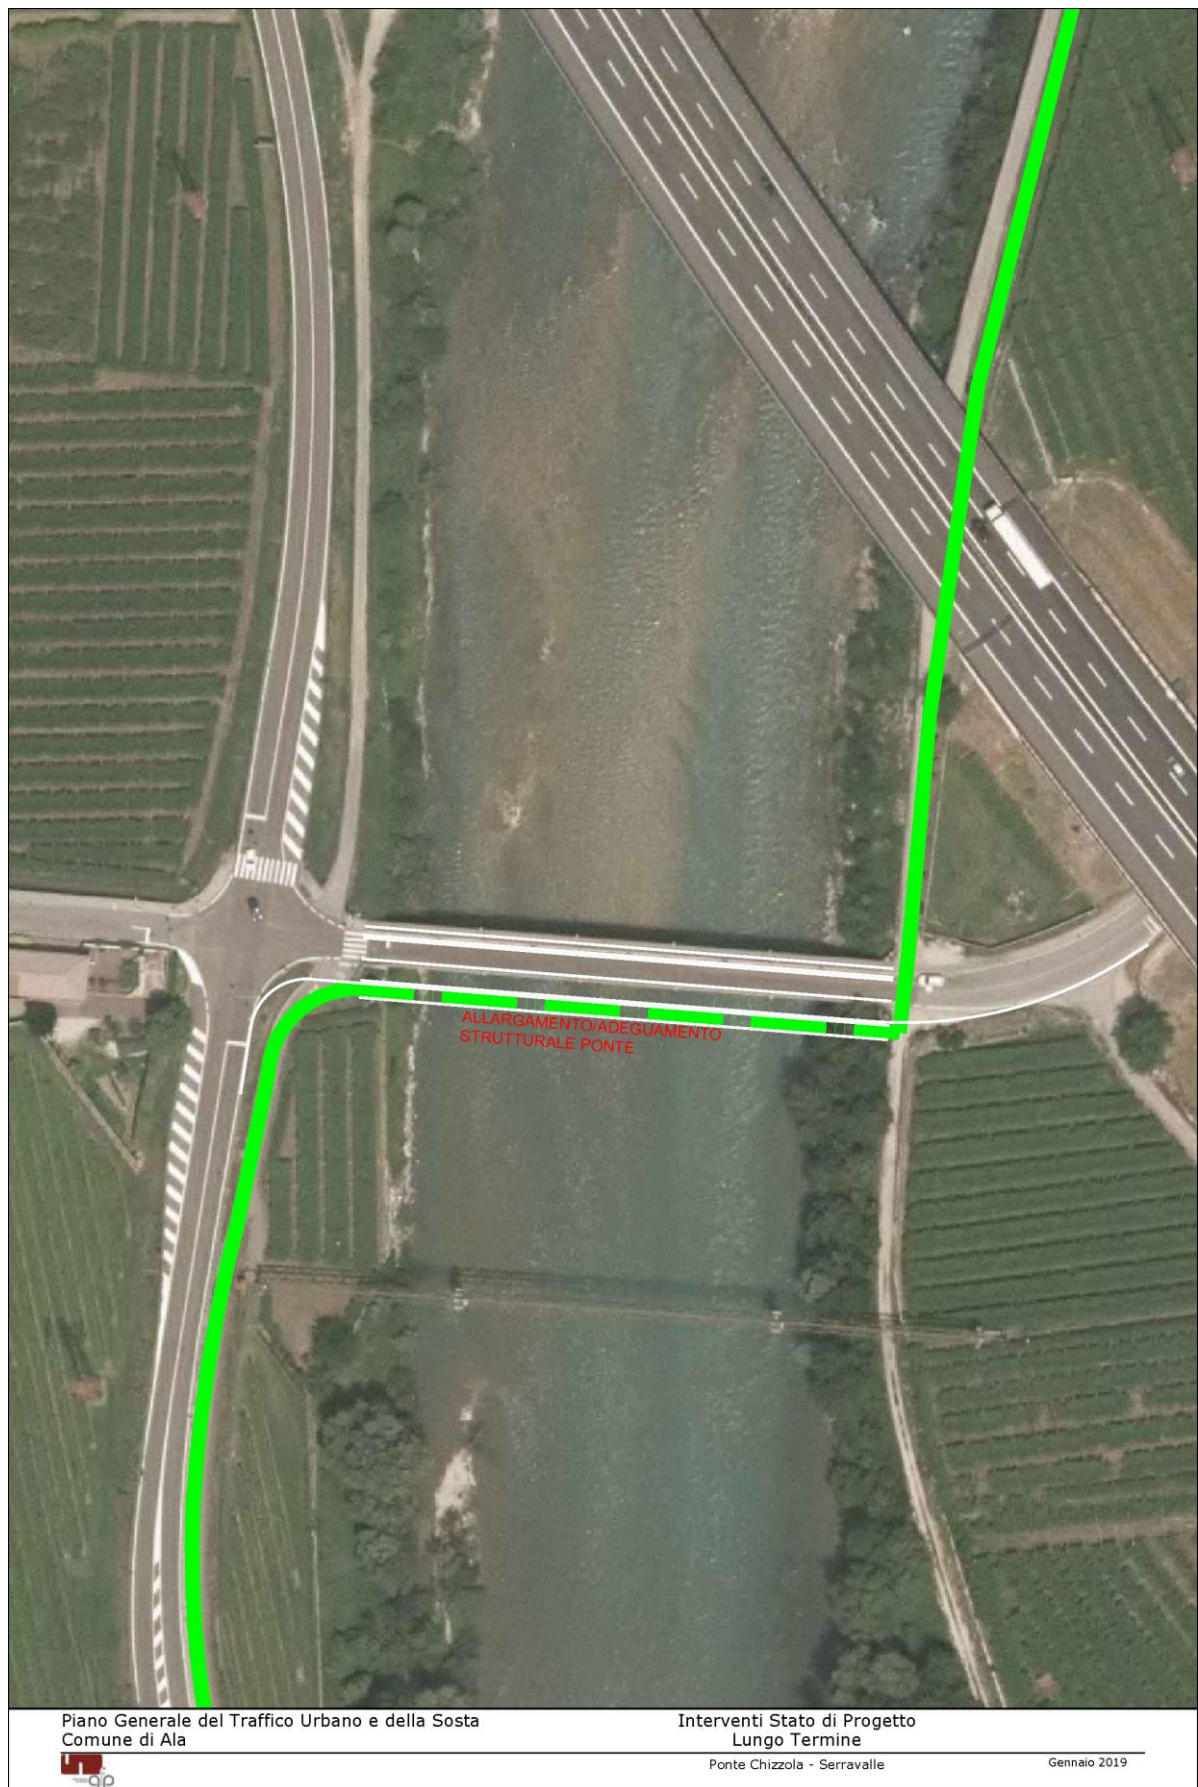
Interventi Stato di Progetto - Lungo Termine - Ponte Chizzola-Serravalle
